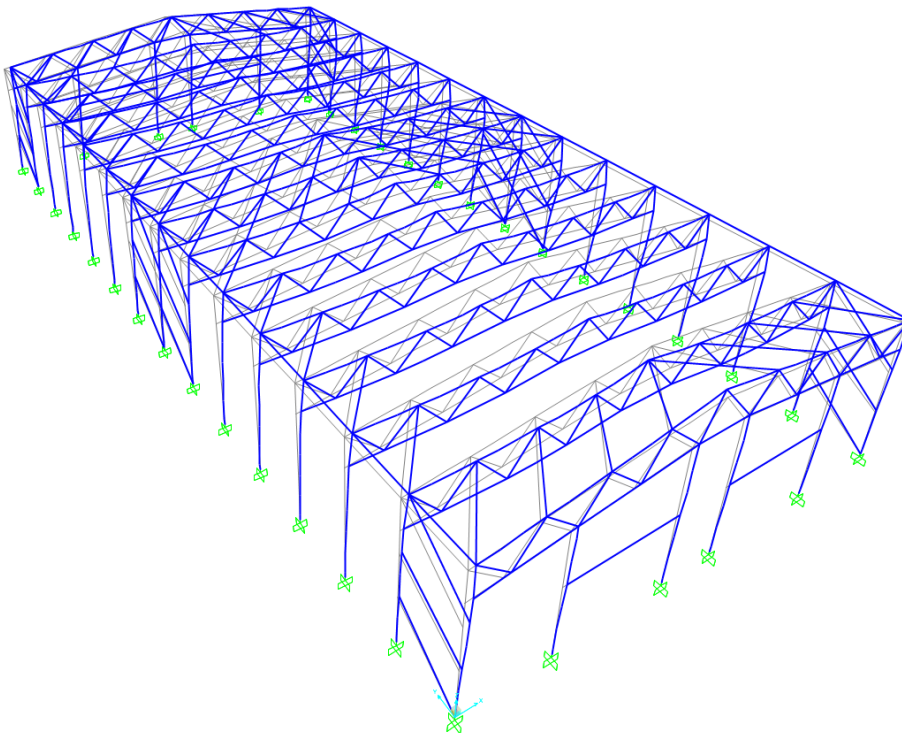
Deformada ELU5 Con arriostramientos transversal y longitudinal
